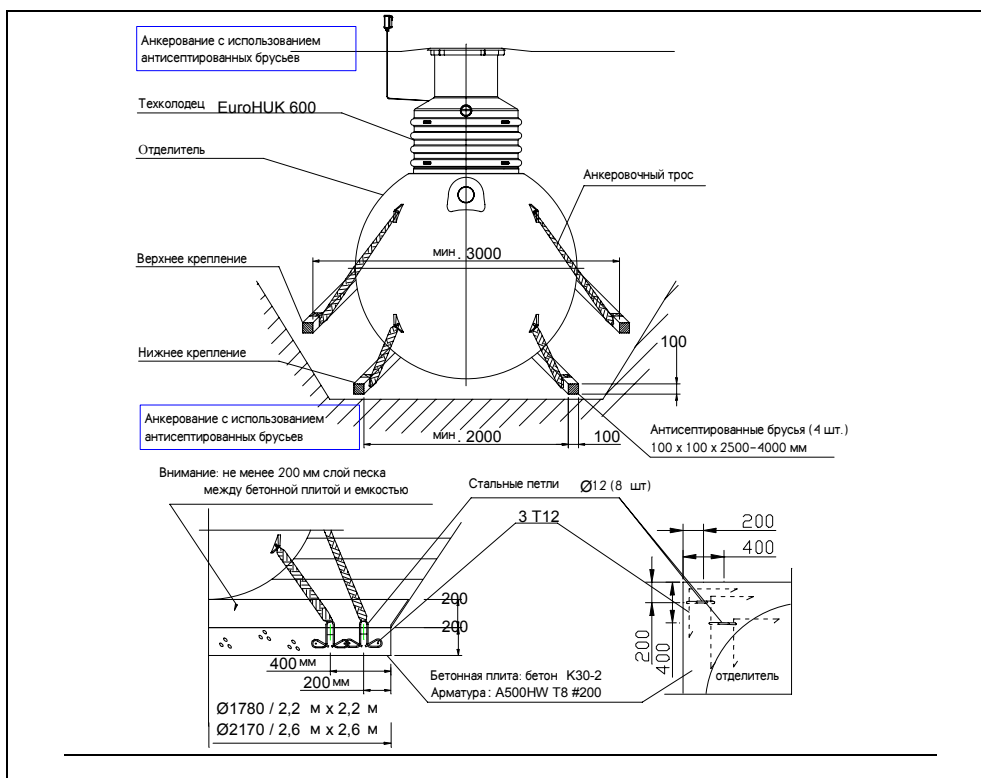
Крепление отделителя при высоком уровне грунтовых вод или слабых грунтах.
